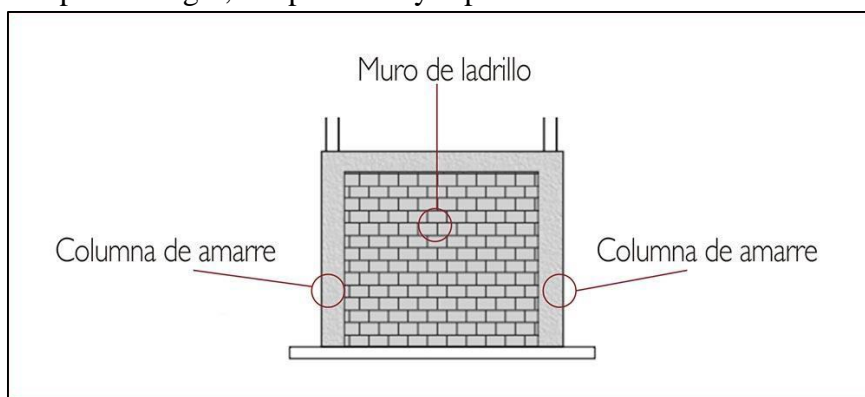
Muro de albañilería, Fuente: concremax (2016).
